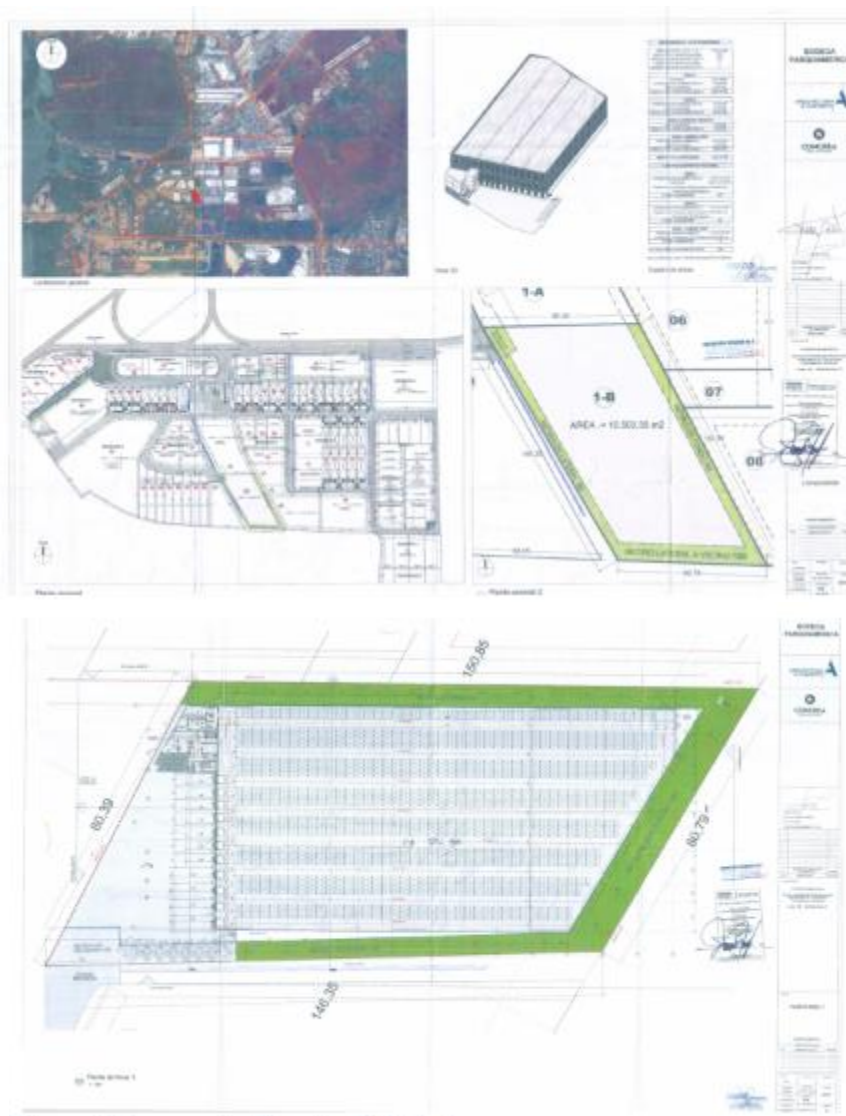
Planos del proyecto. Fuente: Solicitante.
